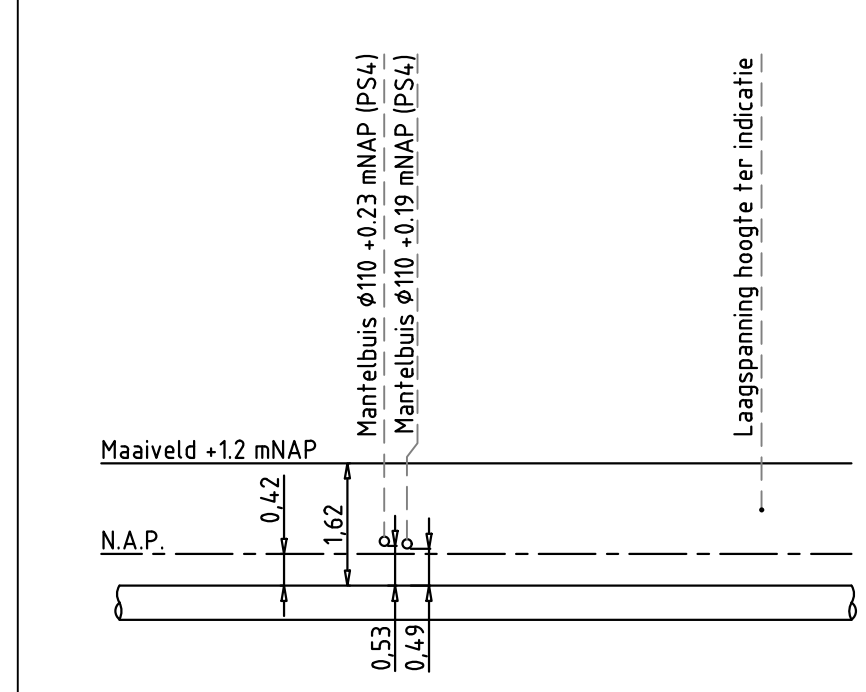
Detail A aanvoer aansluiting op HDD - Schaal 1:100
